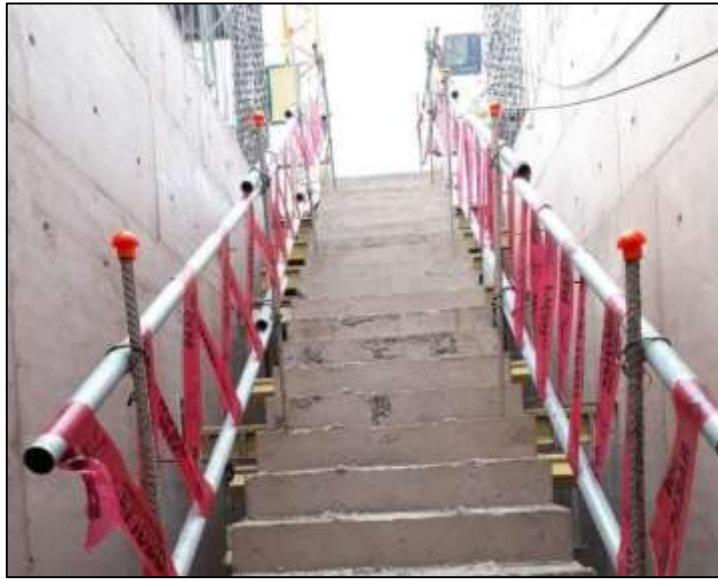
se observa el ajustado de las varillas de aluminio, ya que se han encontrado flojas. La varilla ha sido fijada en el suelo.
